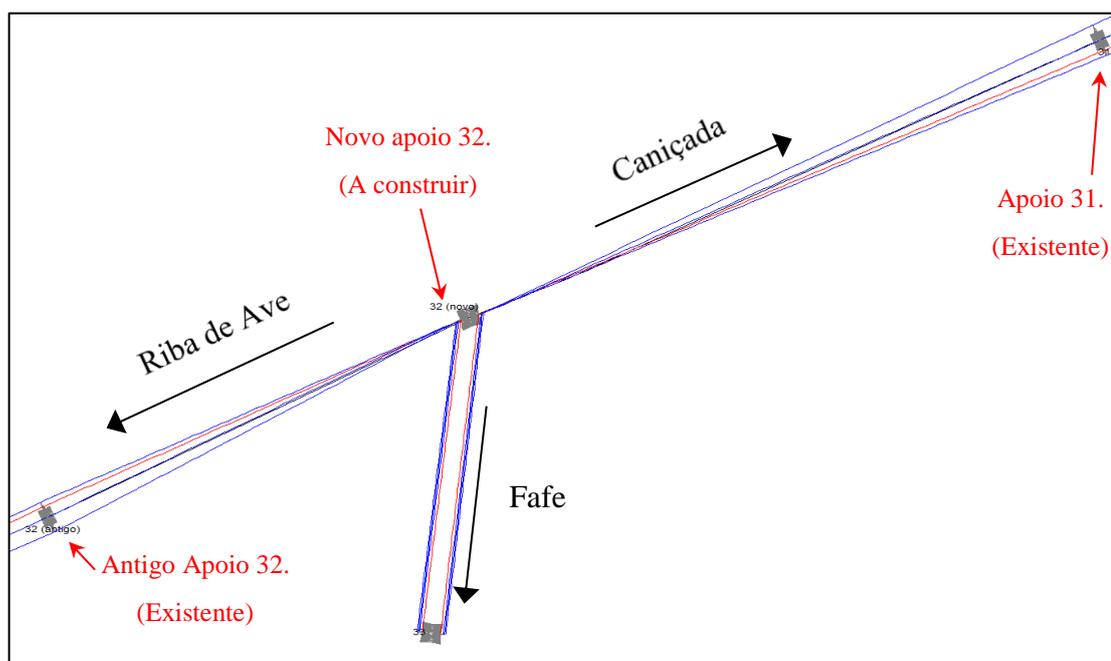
Abertura da LCDRA2 - Postes 31 e 32 (antigo) e novo poste 32 e 33 a construir. Vista de Planta
